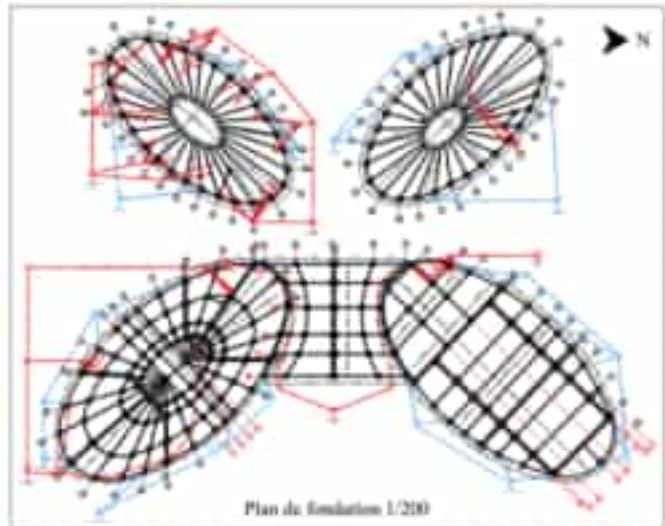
Plan de fondation du centre multifonctionnel / Source : auteur
